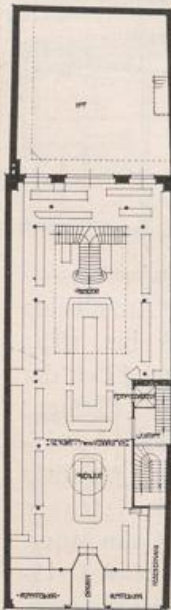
Bolkerstrasse 19/21. Erdgeschoss. 1:500.
